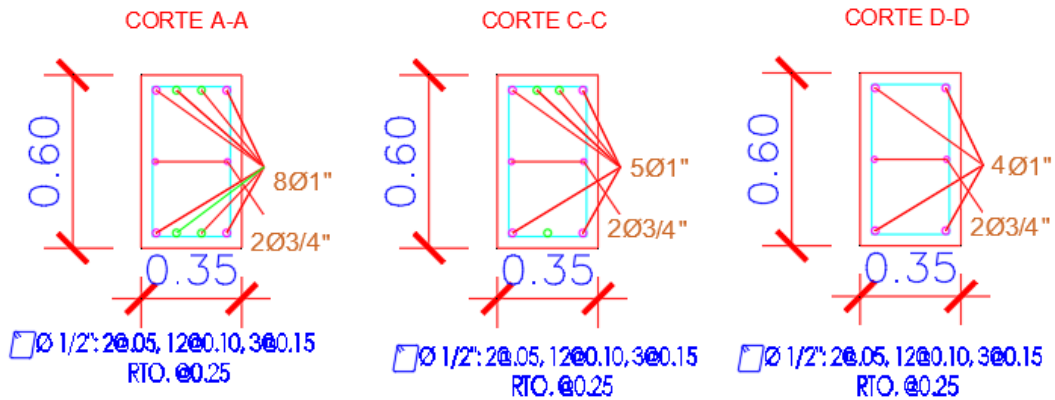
Secciones de Viga con Refuerzo 5° Piso
